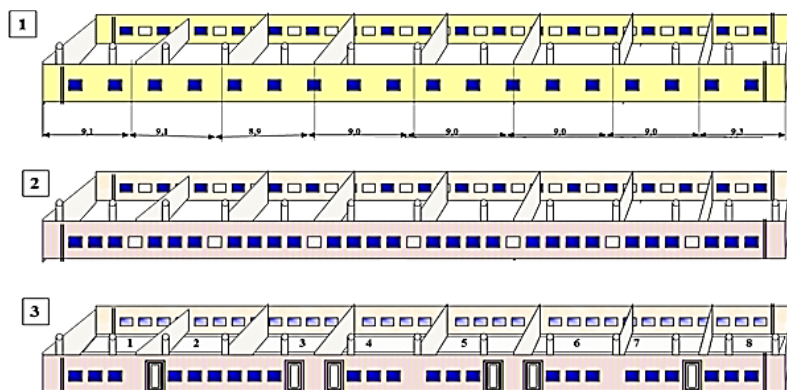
Схема реконструкции оконных и дверных проемов в здании фермы, реабилитируемой в жилой дом (1-й этаж):
